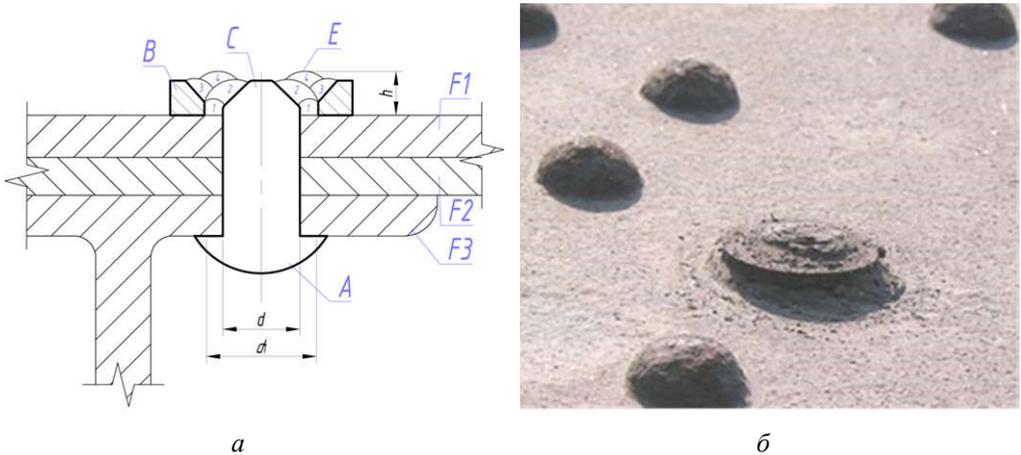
Технологические решения восстановления головки заклепки постановкой шайб на электросварке: *а* – конструктивное решение (А – закладная головка; В – шайба, С – замыкающая головка и стержень заклепки, подверженные коррозионному износу, F1...F2 – соединяемые детали, E – наплавляемые валики сварного шва); *б* – фрагмент восстановленного узлового соединения путепровода
